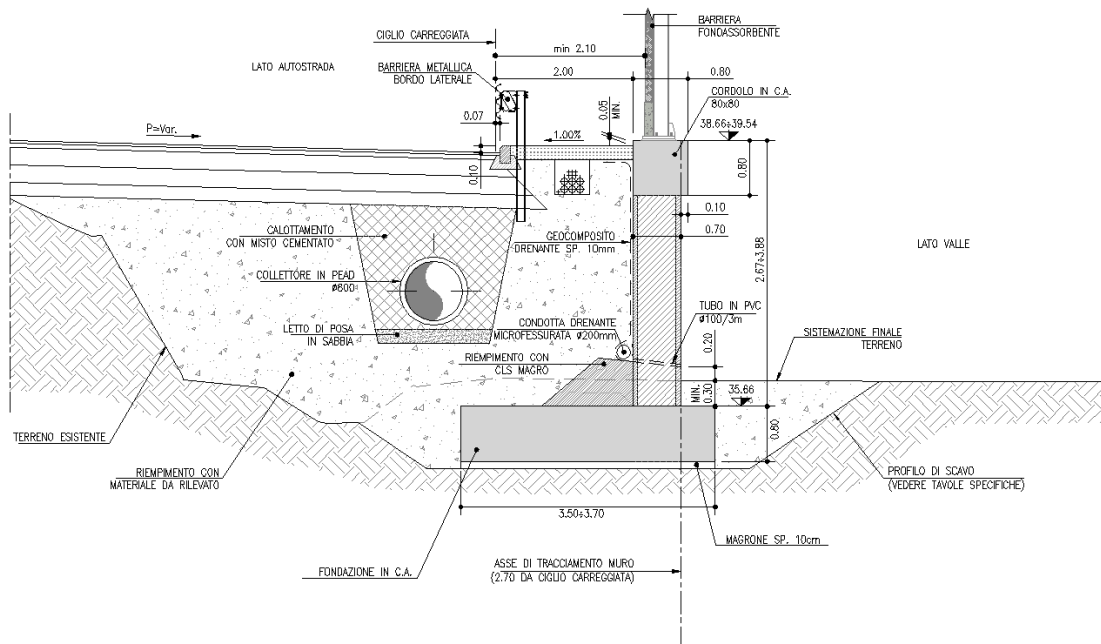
Sezione tipo opera di sostegno MS04 con elevazione prefabbricata
